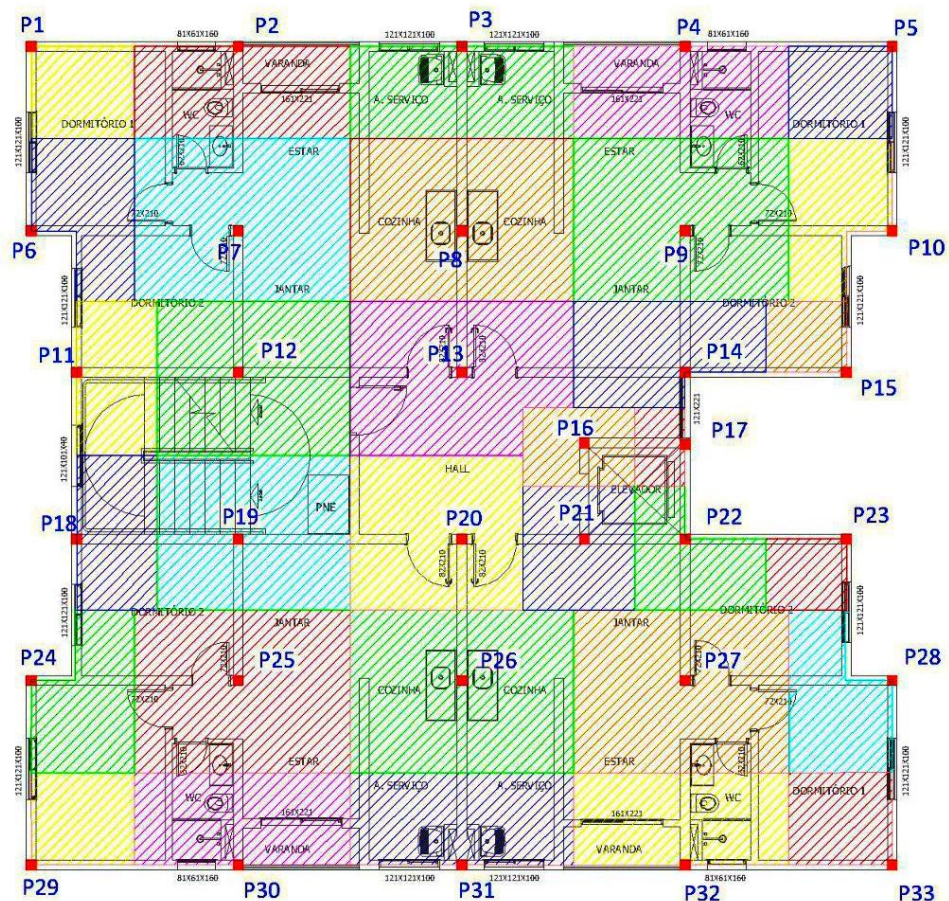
Área de influência dos pilares da segunda concepção estrutural (Fonte: autor próprio)
